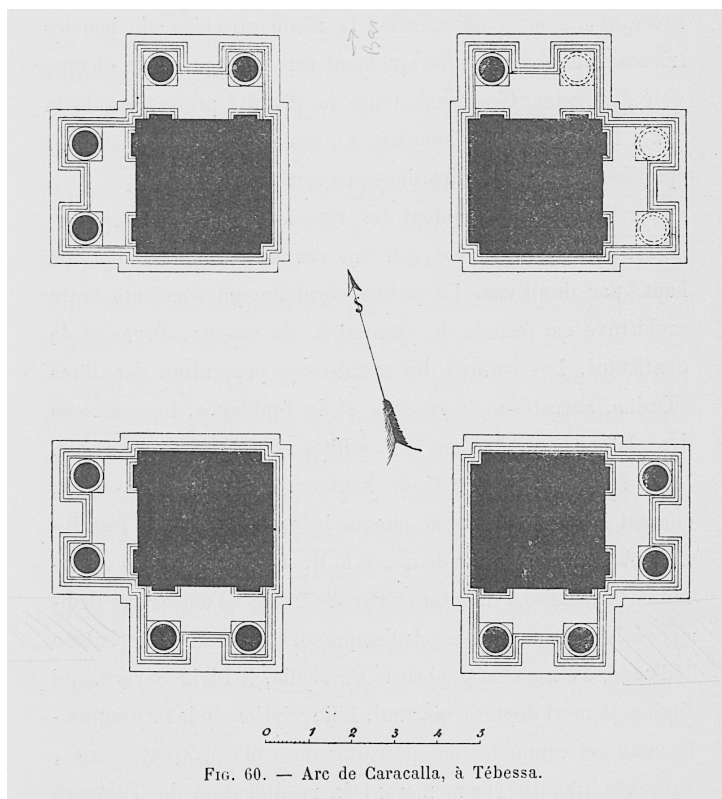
Grundrissplan, Teträpylon in Teveste
